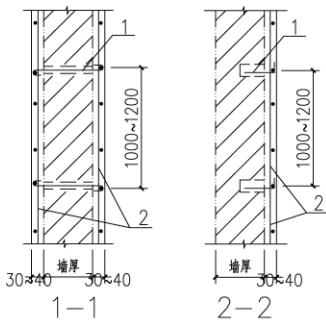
钢筋网水泥砂浆面层加固剖面图
